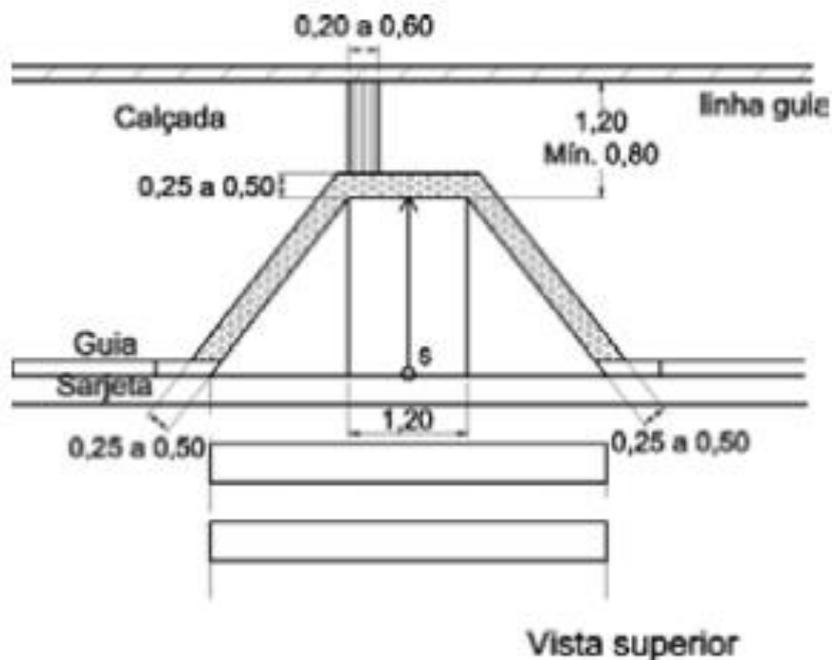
COMPOSIÇÃO DE SINALIZAÇÃO TÁTIL DE ALERTA E DIRECIONAL NOS REBAIXAMENTOS DAS CALÇADAS – EXEMPLO
